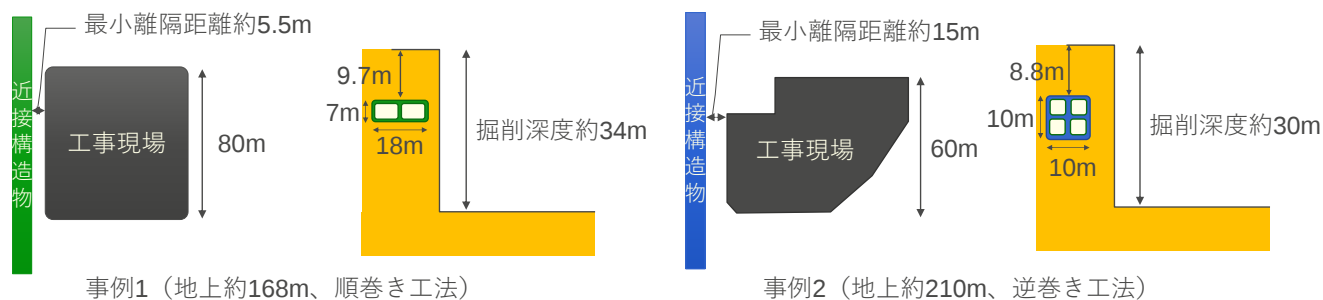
近接施工事例（施工エリアと地下構造物の配置概要）
